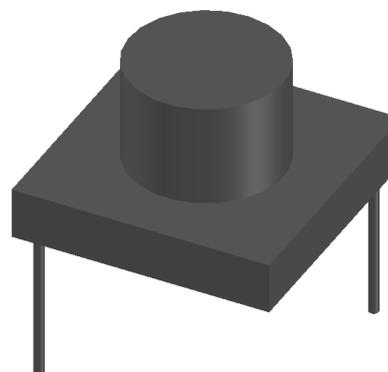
Modelo da base de concreto para fixação dos tubos de papelão. Fonte: Elaborado pelos autores
